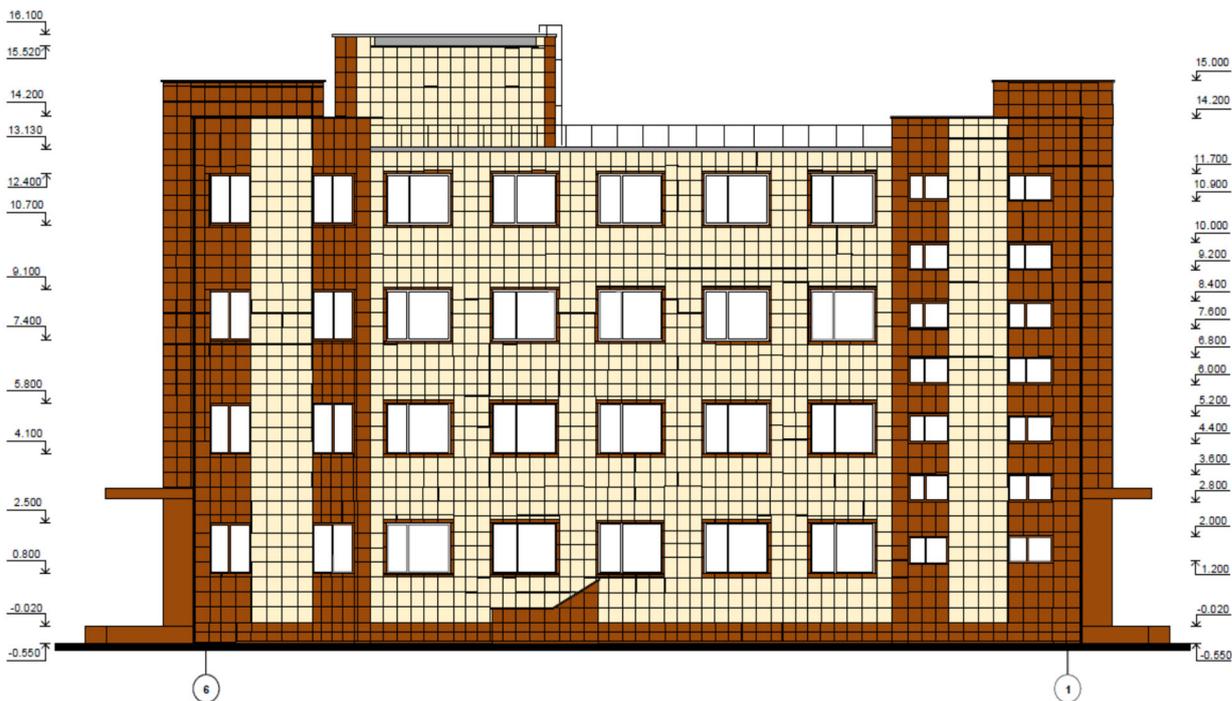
а – фасад будівлі в осях 6-1, вздовж осі Д.
